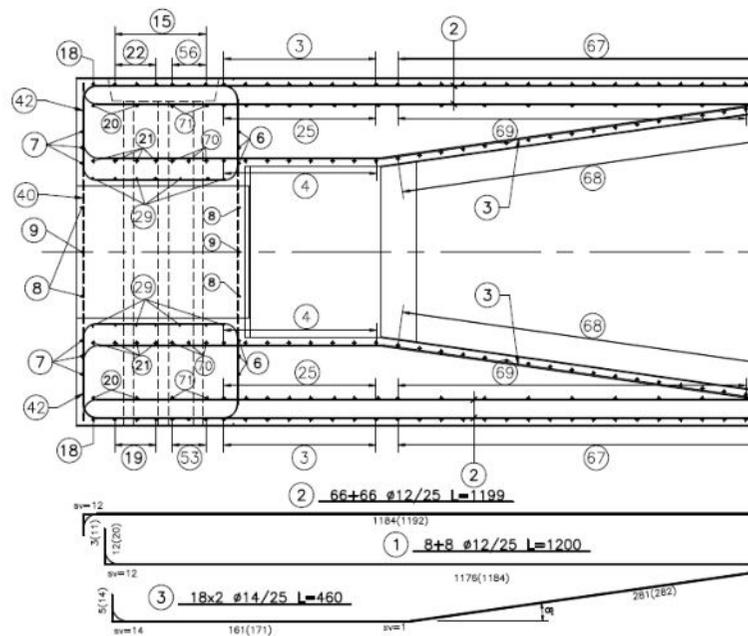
Esempio di armatura della testata di una trave pre-tesa a cassoncino: pianta
